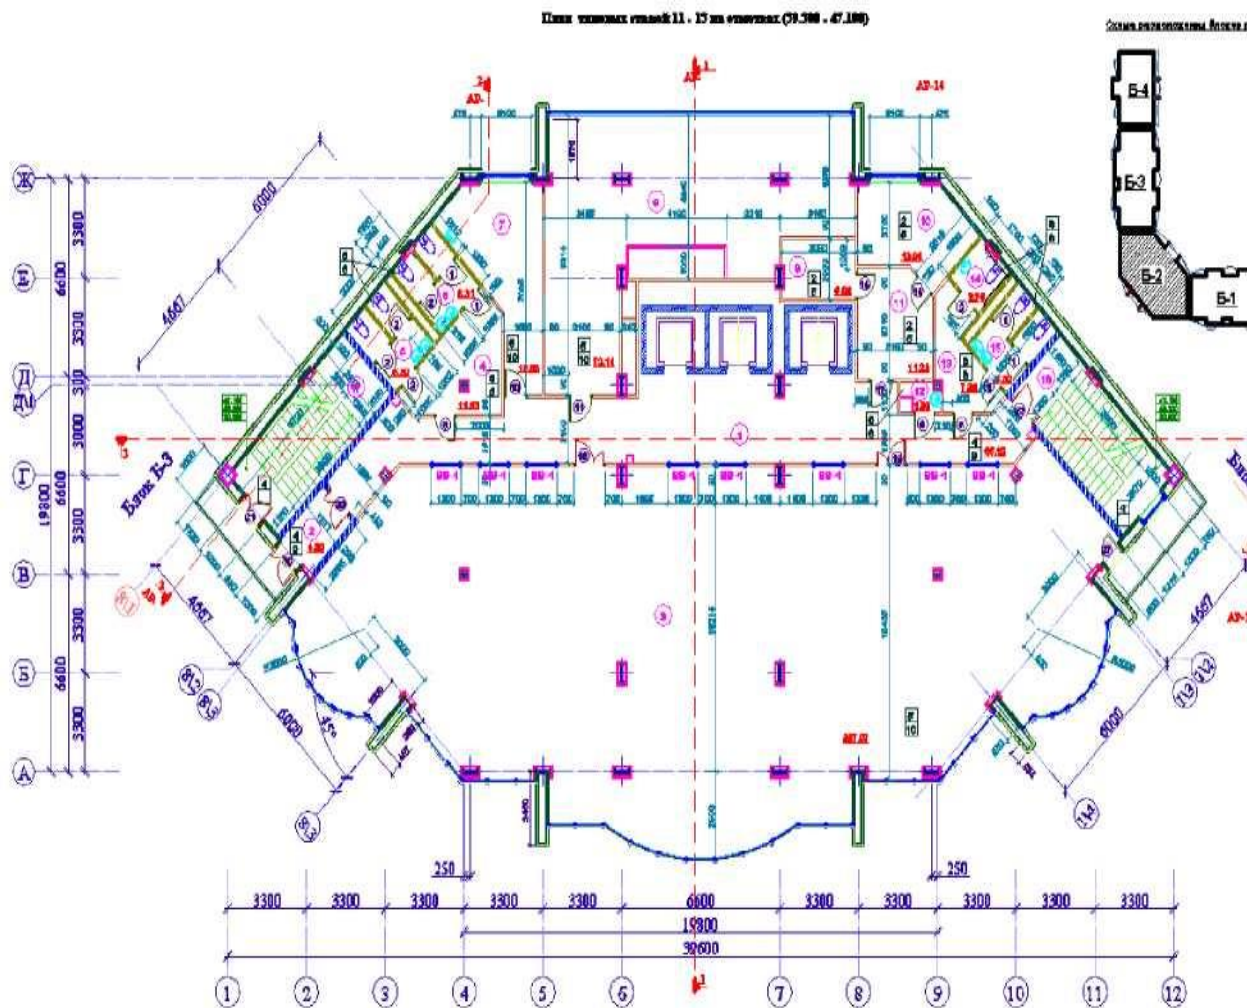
План типового поверху висотного комплексу «Арай»
